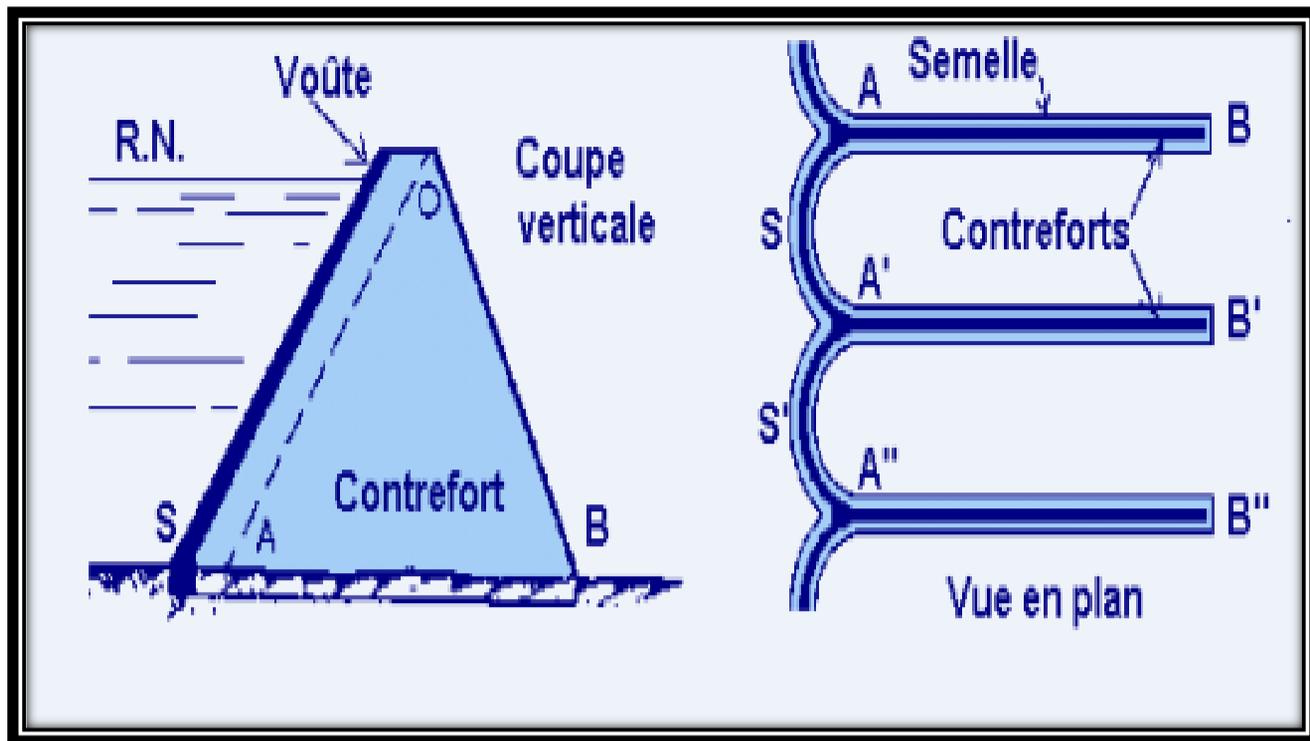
Coupe transversale et vue en plan de barrage à contreforts (ANTON et HENRI, 2011)
